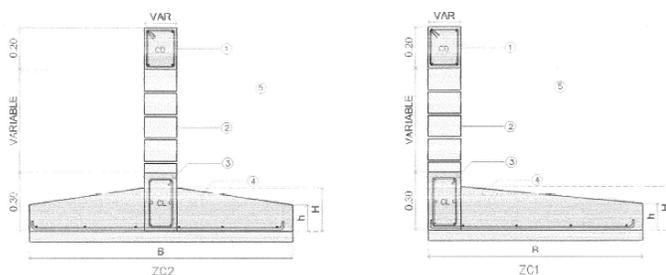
Cimentaciones que serán utilizadas en el proyecto
